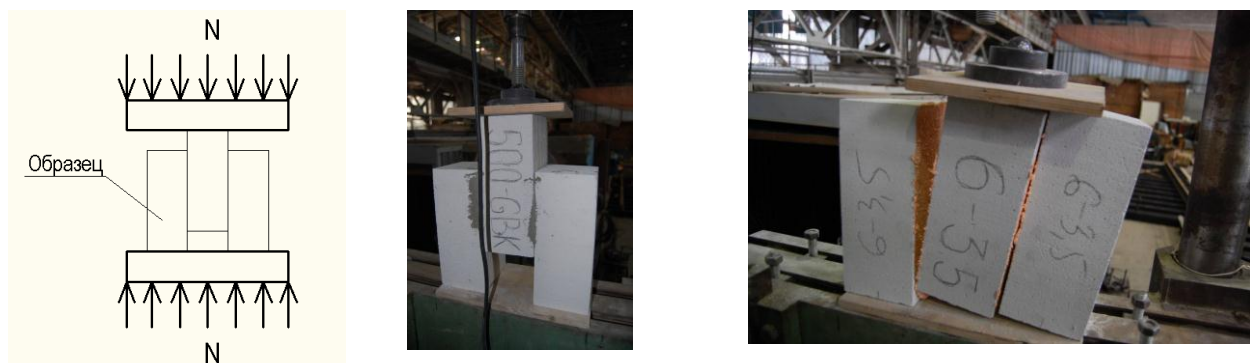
Схема испытания, общий вид испытательной установки и испытанный образец при определении касательного сцепления в кладочном шве
